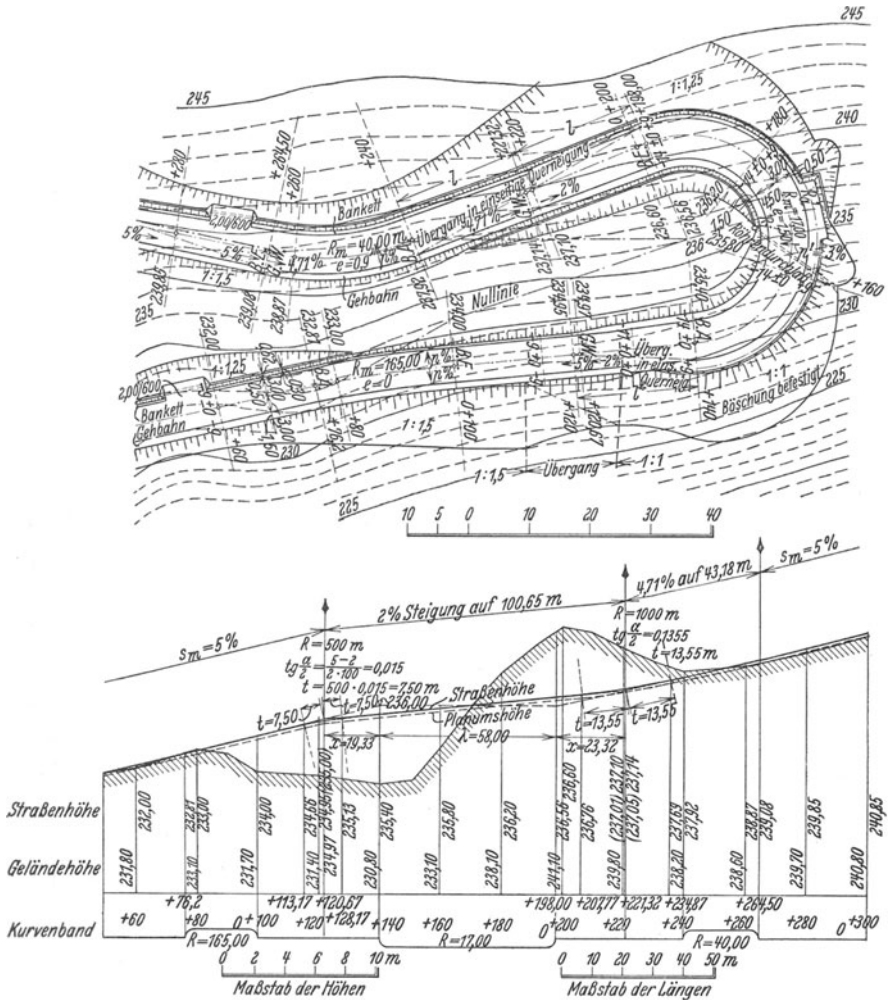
Entwurf einer Wendeplatte im Grundriß und Aufriß.
